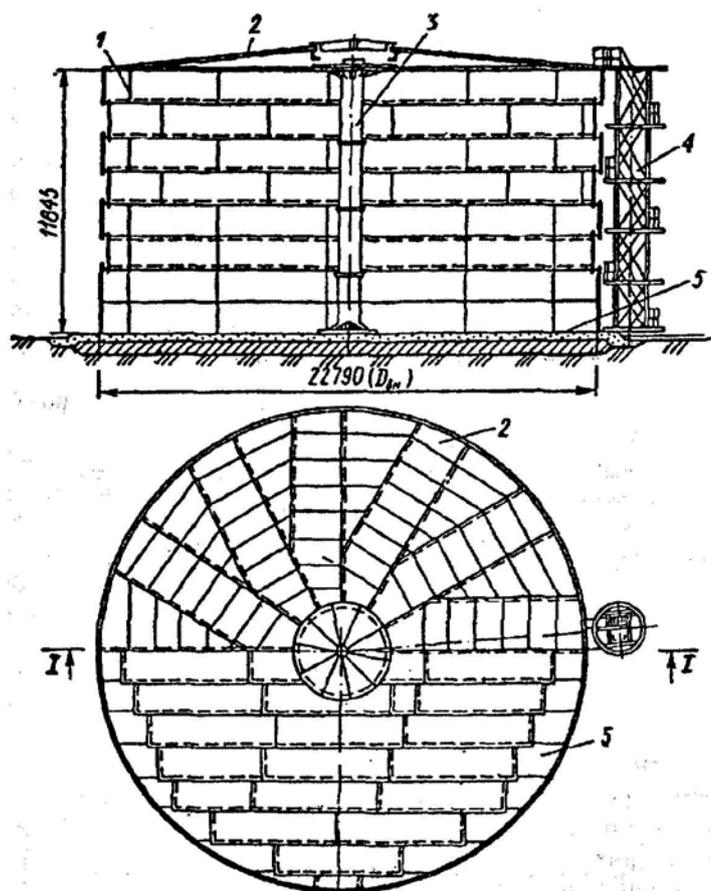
Вертикальный цилиндрический резервуар объемом с щитовой кровлей: 1 - корпус; 2 - щитовая кровля; 3 - центральная стойка; 4 - шахтная лестница, 5 – днище
